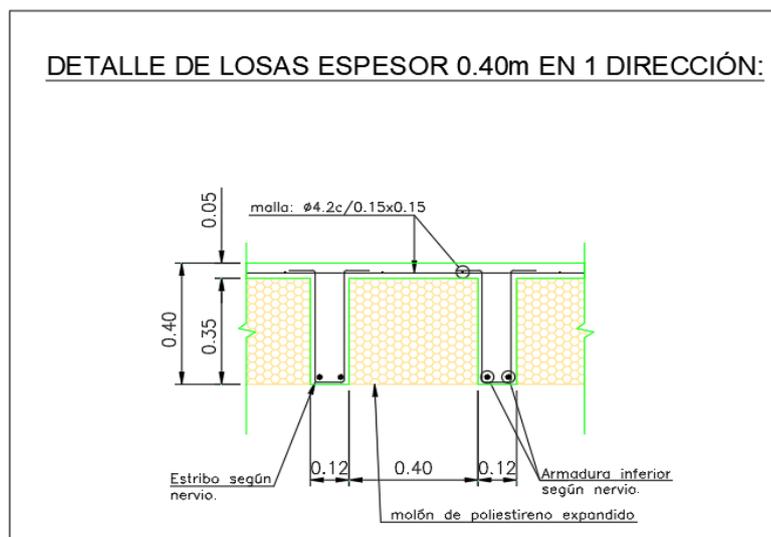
Corte Nervio transversal de losas macizas.
